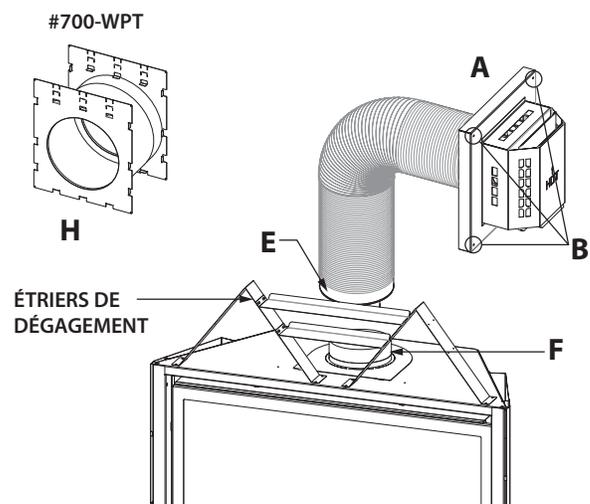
, Assemblage et installation du kit de terminaison (Série n° 700-2)
